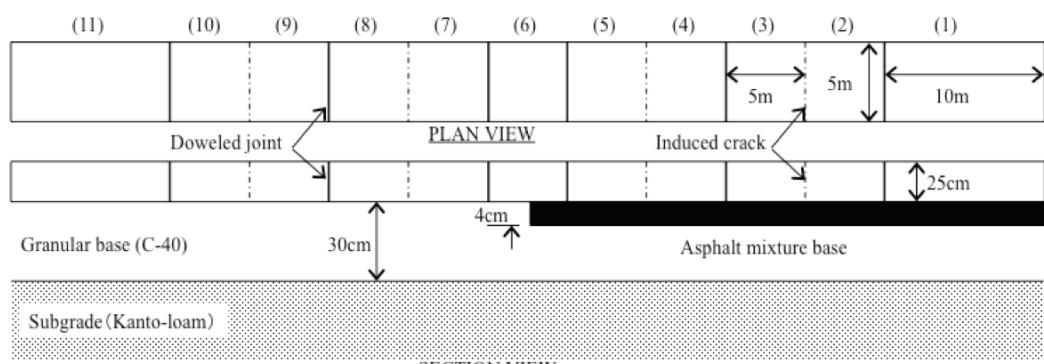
土木研究所に施工したコンクリート舗装の平面図(上)および断面図(下)
